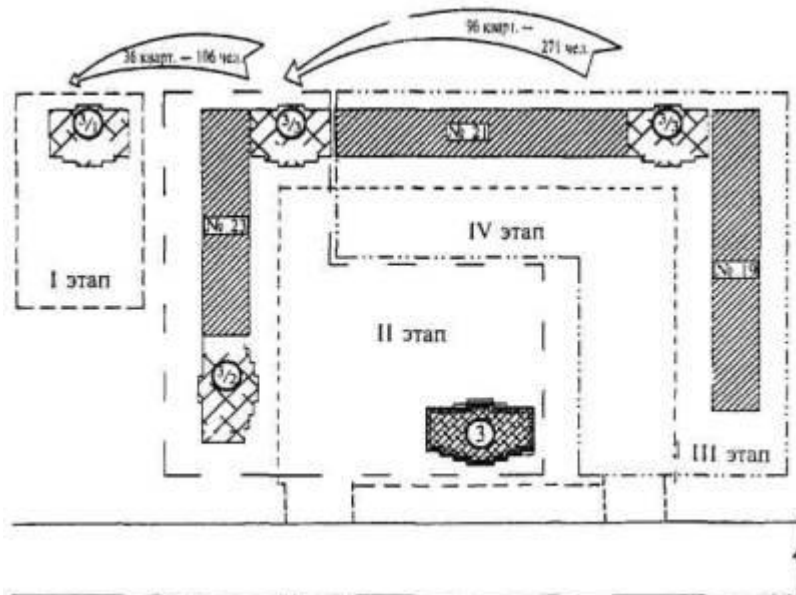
Поэтажный план реконструкции группы жилых домов по ул. Малая Ботаническая
